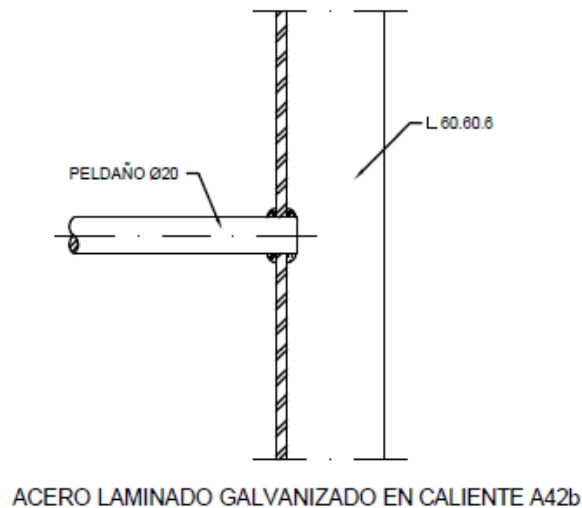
Detalle de la soldadura del peldaño al perfil de la escalera.
